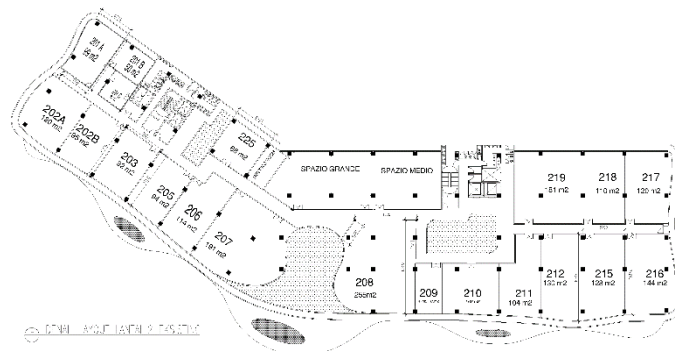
Denah Lantai Dasar Spazio, (Dokumen Badan Pengelola Bangunan Spazio, 2015)
